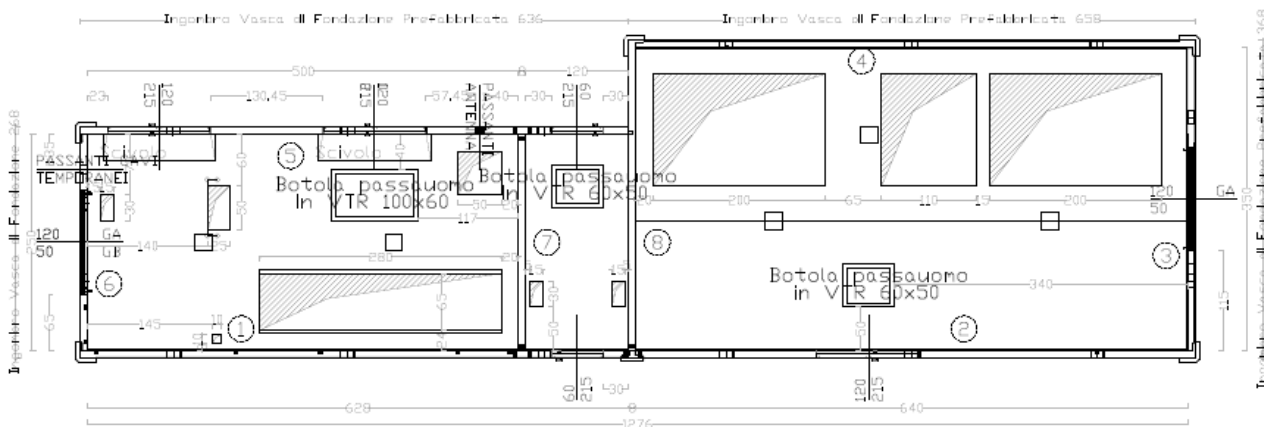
Sezioni - Fabbricato FA1G – progetto in variante
